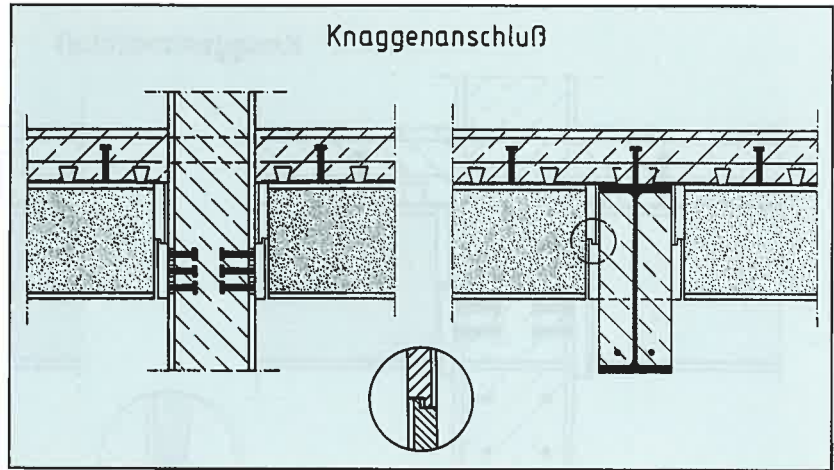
Brandgeschützter Knaggenanschlusses mit Lagesicherung
